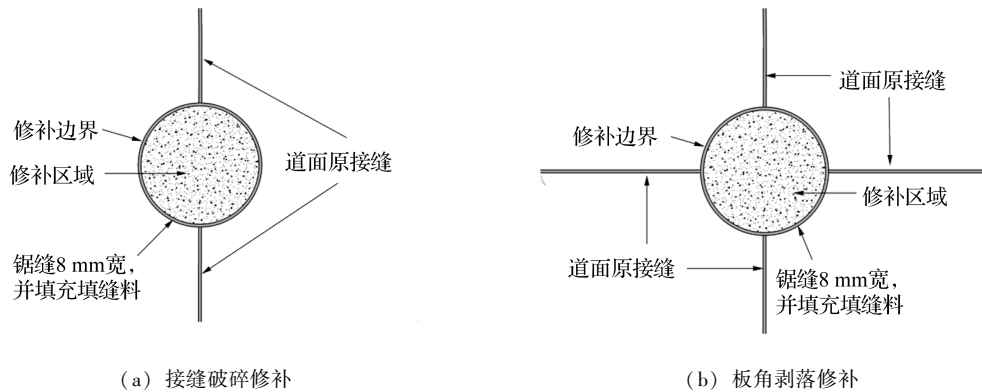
部分厚度圆形补块修补平面布置示意
